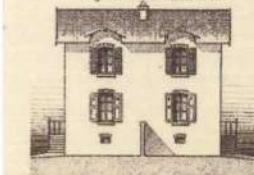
Château Coupe N°2 suivant à la façade (Fig. 32).
